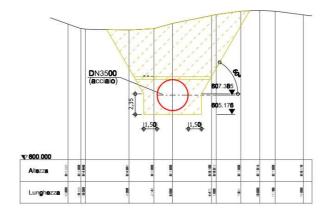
Sezione di posa della condotta forzata subito a monte del previsto attraversamento.
